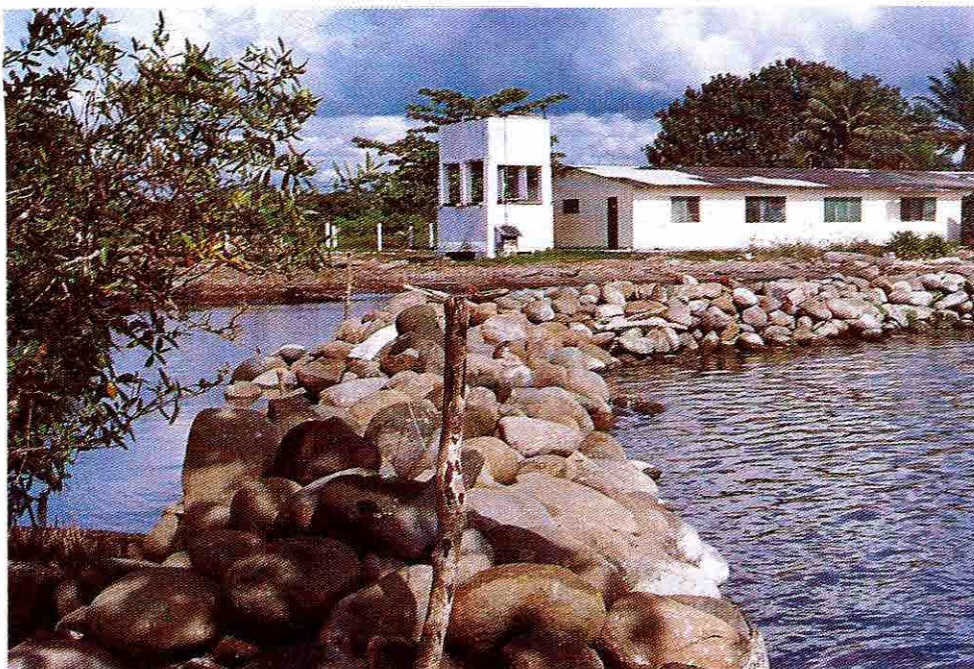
Características finales de la defensa de playas frente al Apostadero Naval de Turbo. 1992.
